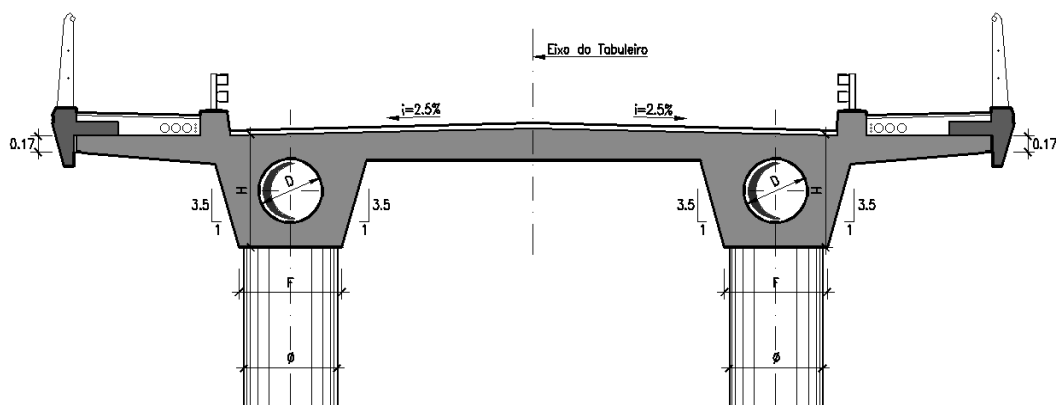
Caracterização da geometria das nervuras dos tabuleiros e dos pilares.
